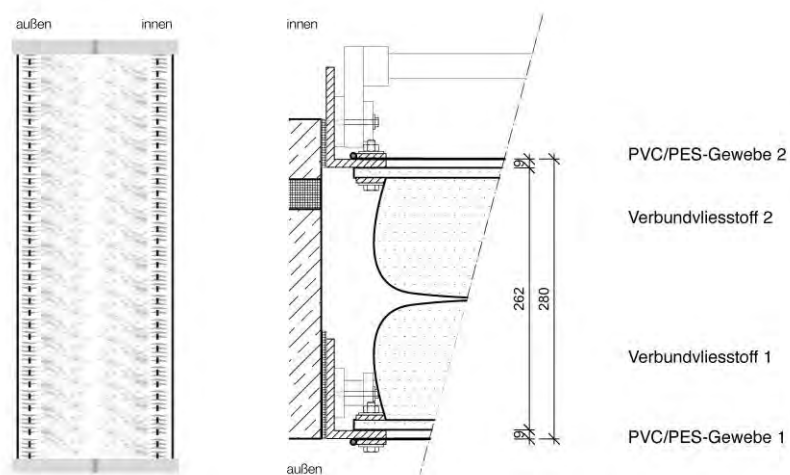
Systemskizzen und Schnitt des Prüfaufbaus B1
